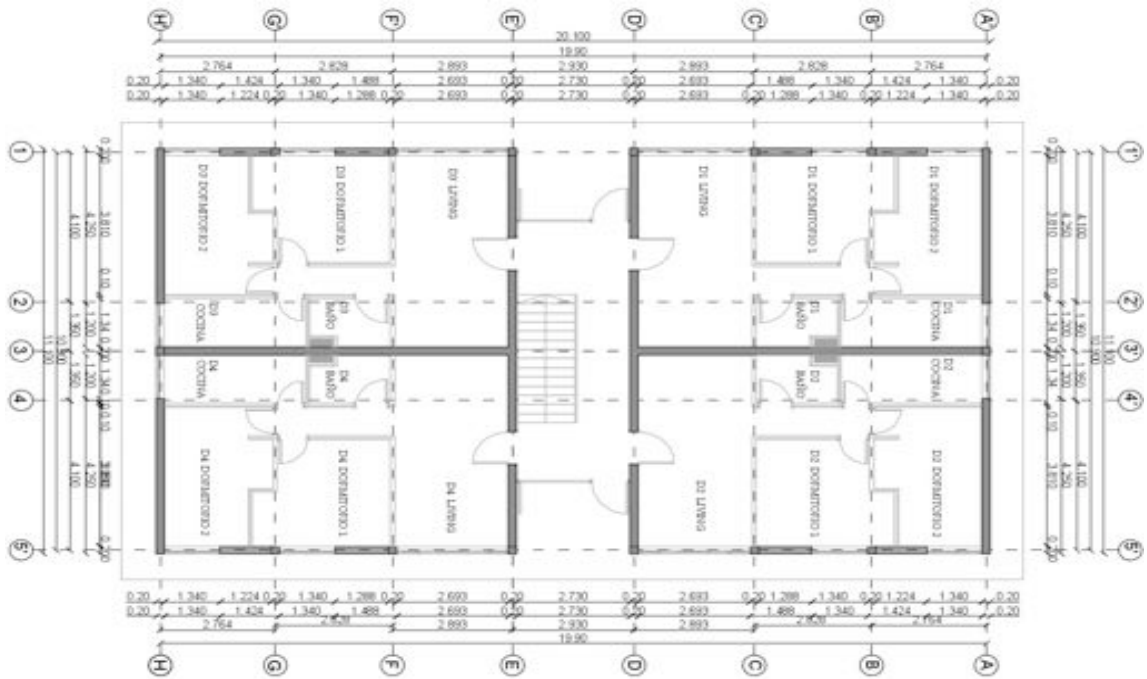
Planta Arquitectura acotada 1º piso Block 1010. Fuente: elaboración propia
